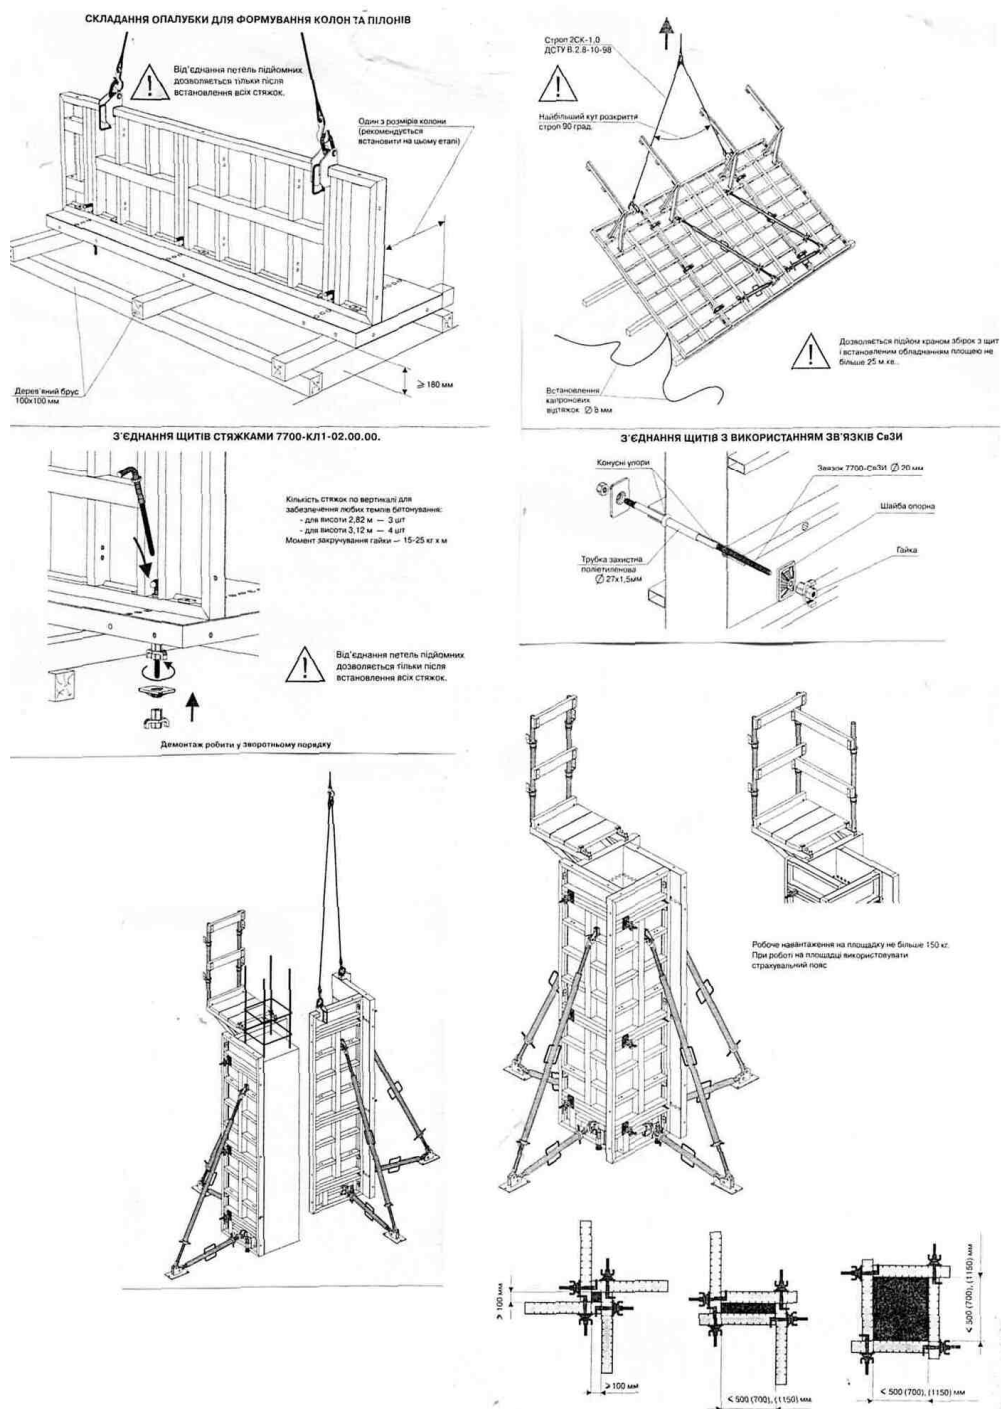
Складання та монтаж опалубки колон, правила стропування панелей опалубки
